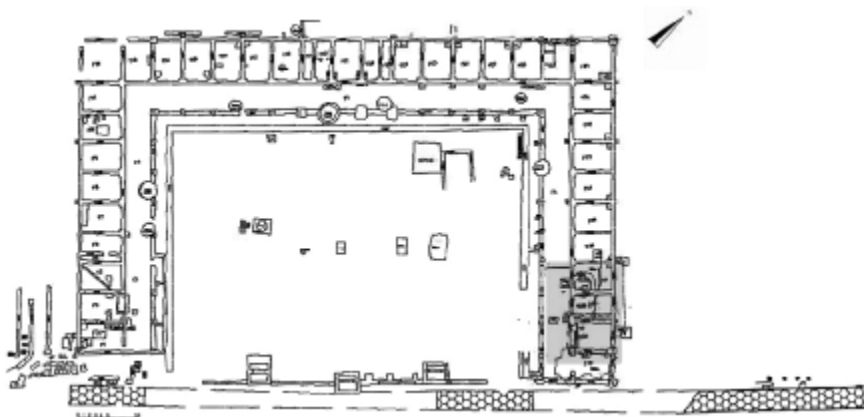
Planimetria del Foro di *Suasa*: in grigio, sul lato nord, l'area con le strutture più antiche (elaborazione E. Vecchietti).
